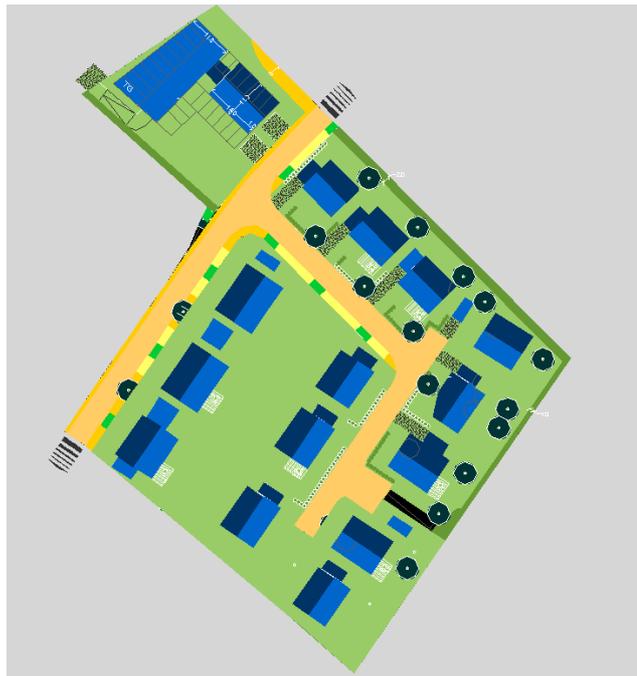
Geplante Wohnbebauung „Pflost“ (aus Entwurf Bebauungsplan „Pflost“)
